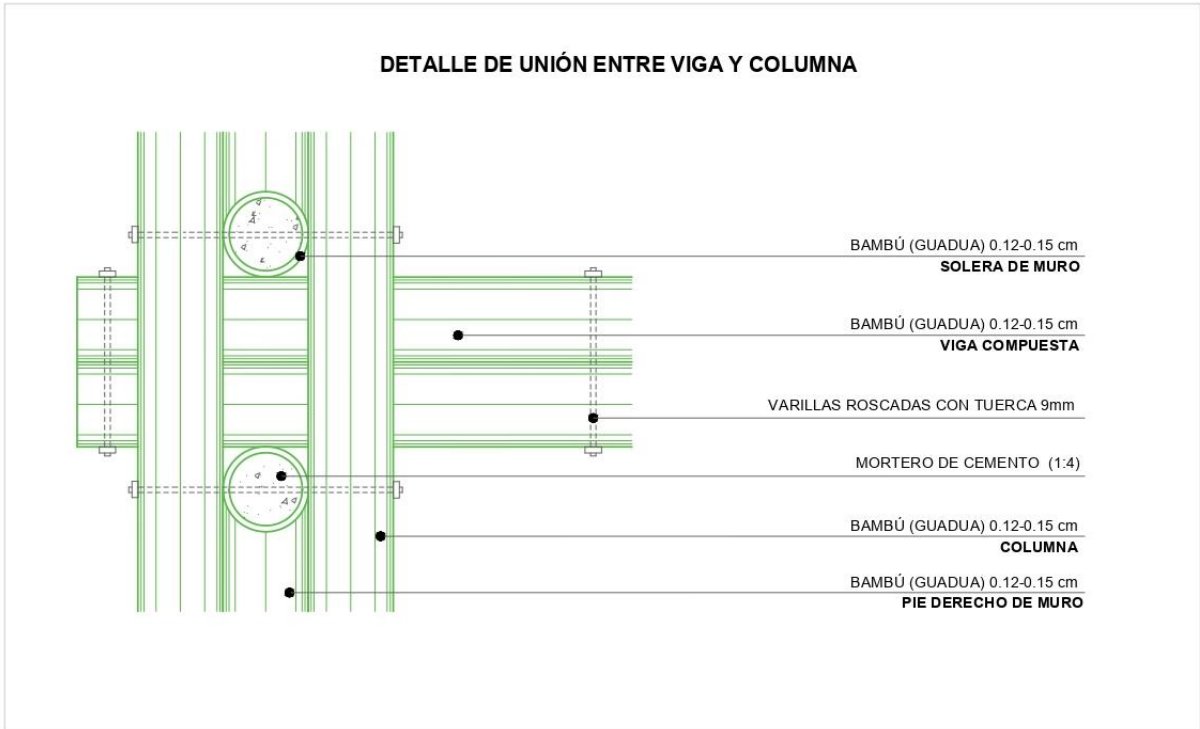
Detalle constructivo de unión de columna y viga compuesta. Fuente: El autor
